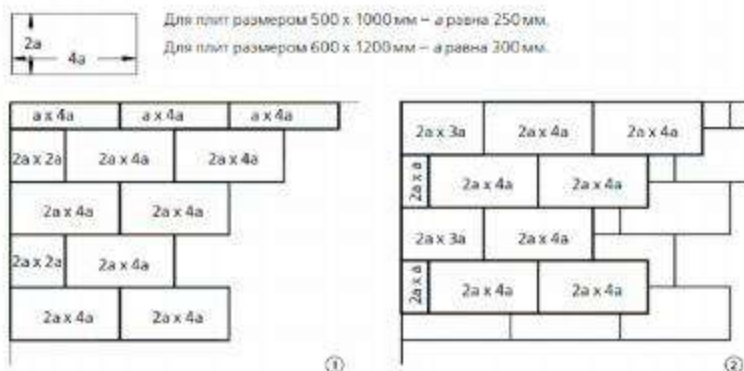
Раскладка теплоизоляционных плит при двухслойной укладке:
